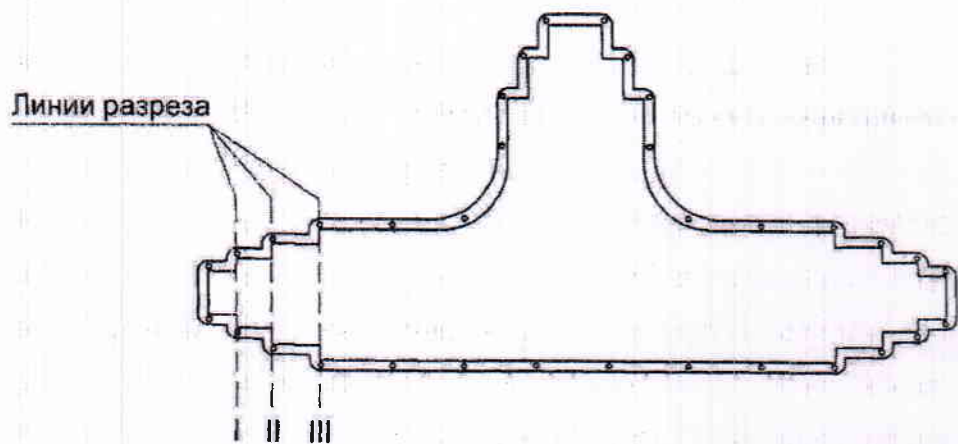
Узел теплогидроизоляции стыков труб ГПИ
